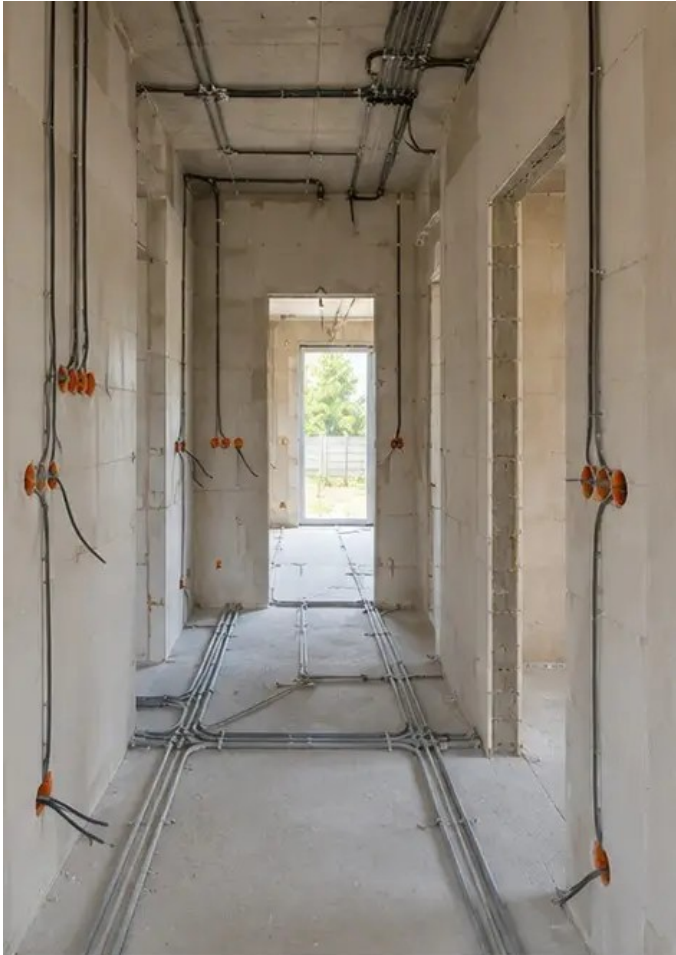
Pemasangan sistem kelistrikan sedang berlangsung
